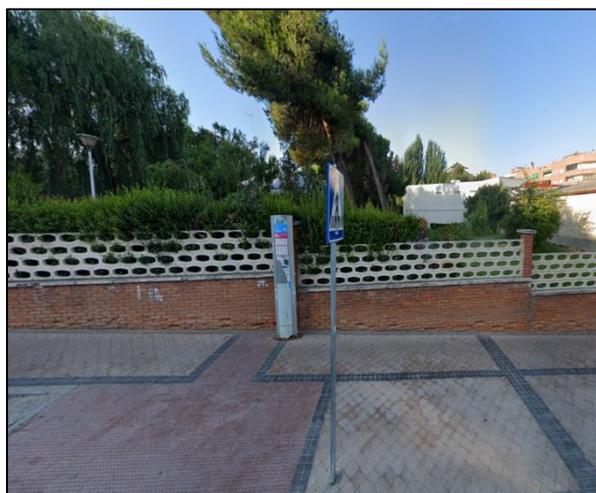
y Figura 6.112: Pavimento sin piezas o elementos sueltos pavimento no deslizante, continuo y duro
